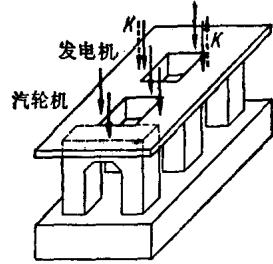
汽轮机钢筋混凝土基础的顶板、支柱和底板
